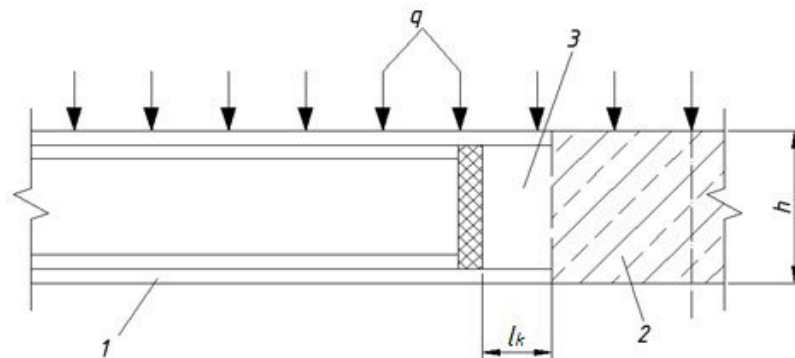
До розрахунку стику багатопустотних плит з несучим ригелем на дію вертикального навантаження (загальний вигляд стику): 1 – багатопорожниста плита; 2 – несучий ригель; 3 – бетонна шпонка
